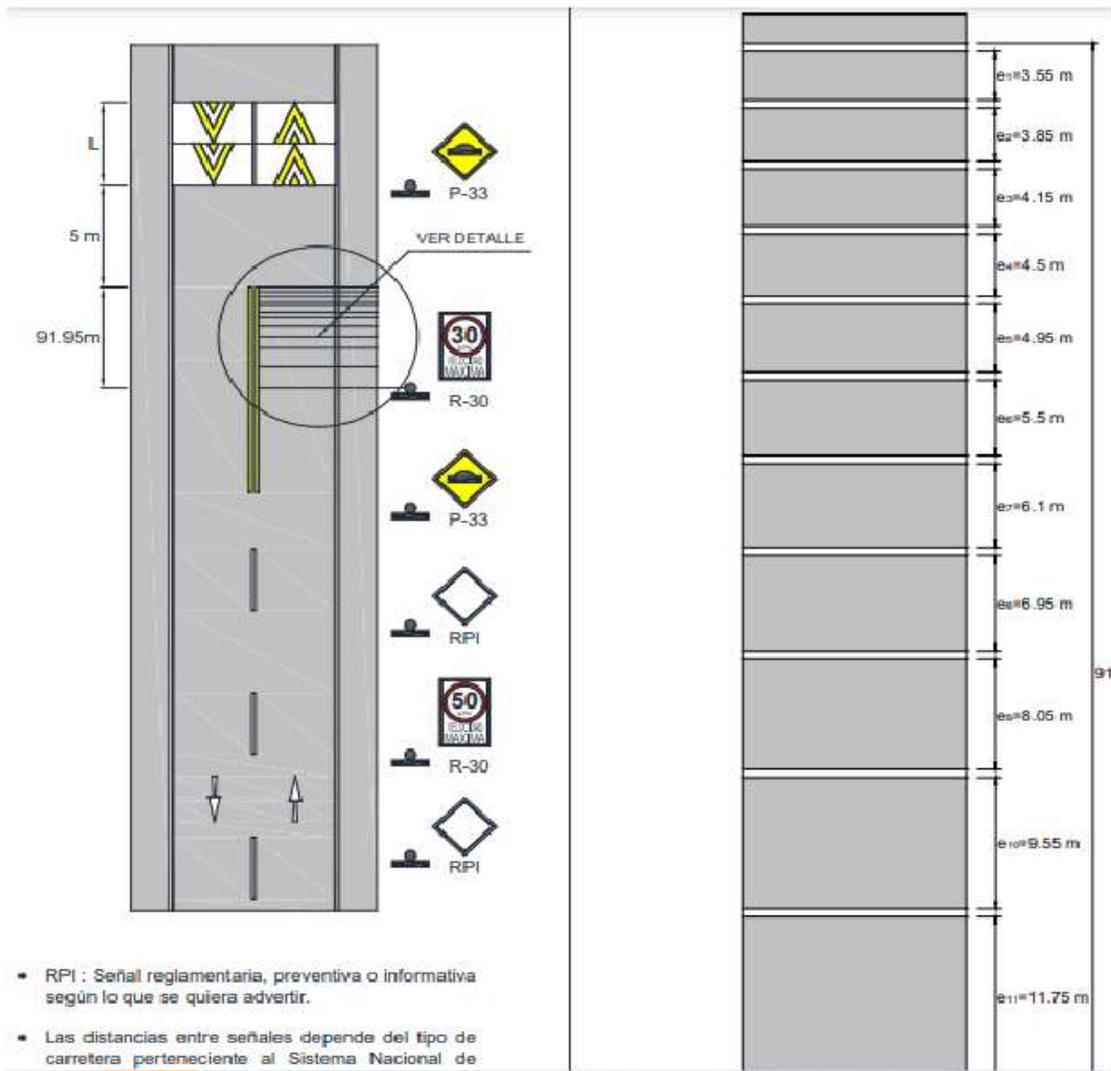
Plano de planta de resalto circular en la Institución educativa Inicial 024.
